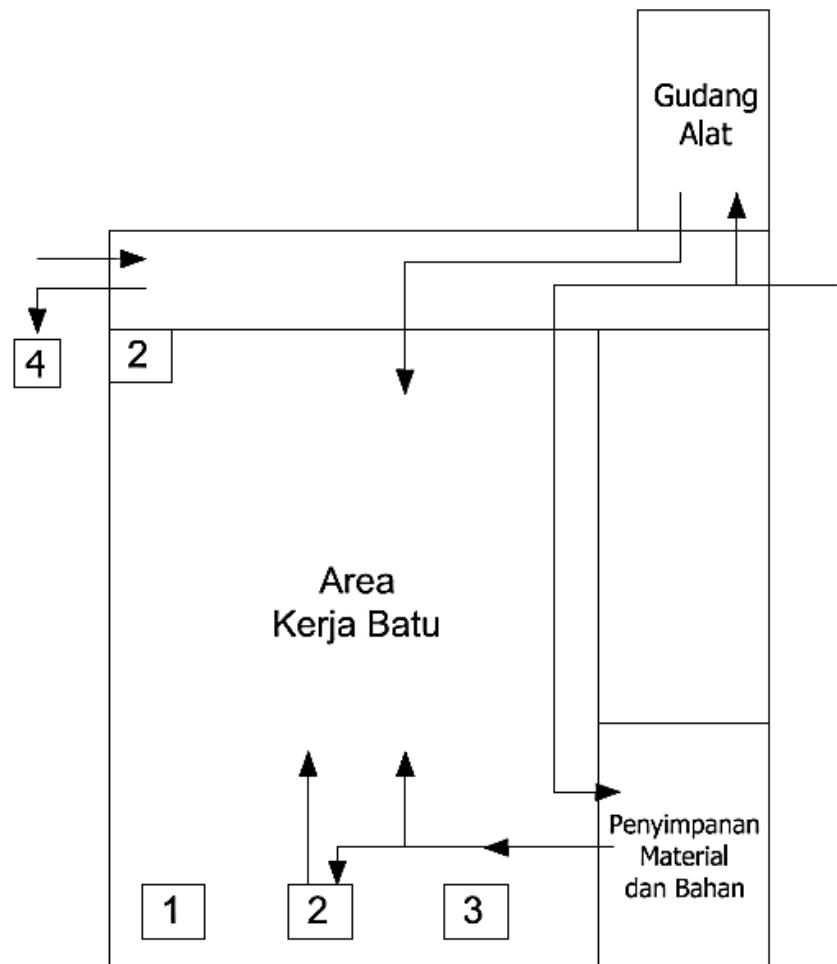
Luas satuan kerja pekerjaan pemasangan pondasi
